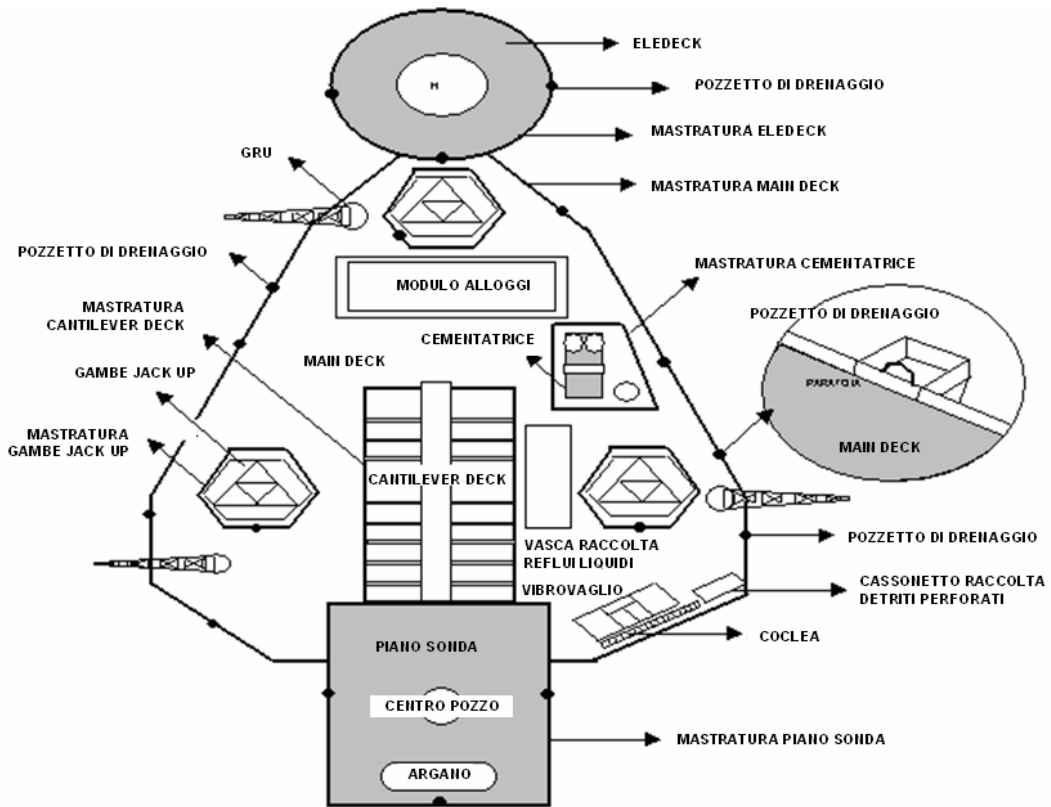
Planimetria Impianto Jack-Up Drilling Unit (Piano Principale)
